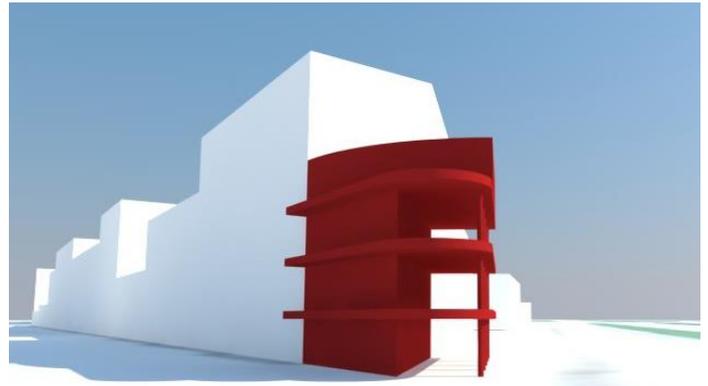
Planteamiento de un relingo: Ejemplo de elementos en situación de pórtico. Fuente de imagen 13,14 y 15: Elaboración propia
